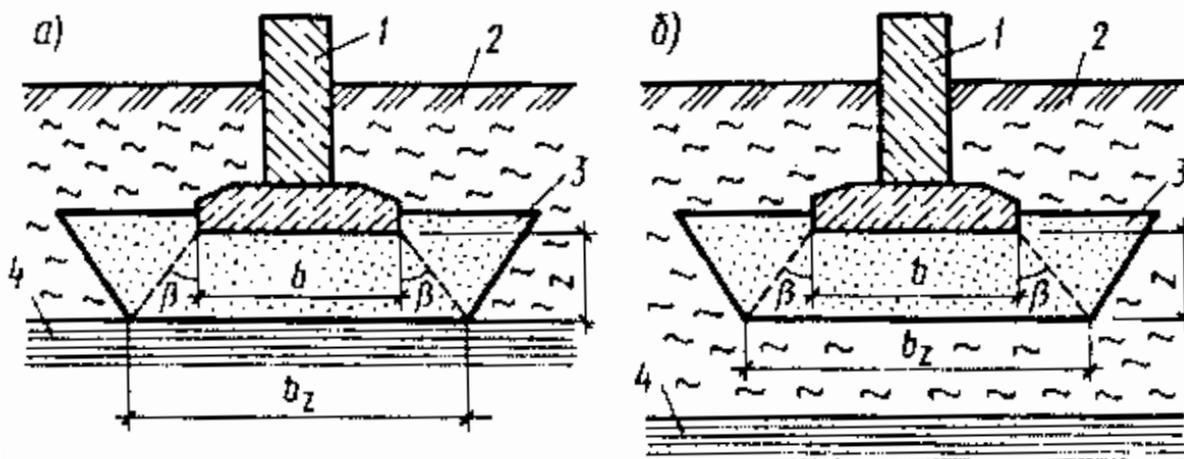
Устройство песчаных подушек при малой (а) и большой (б) толще слабых грунтов:
